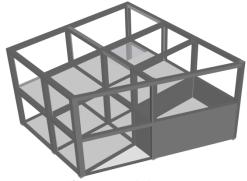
Modélisation 3D de la structure porteuse des bungalows vue sur mer. Source : Auteures, 2025.
